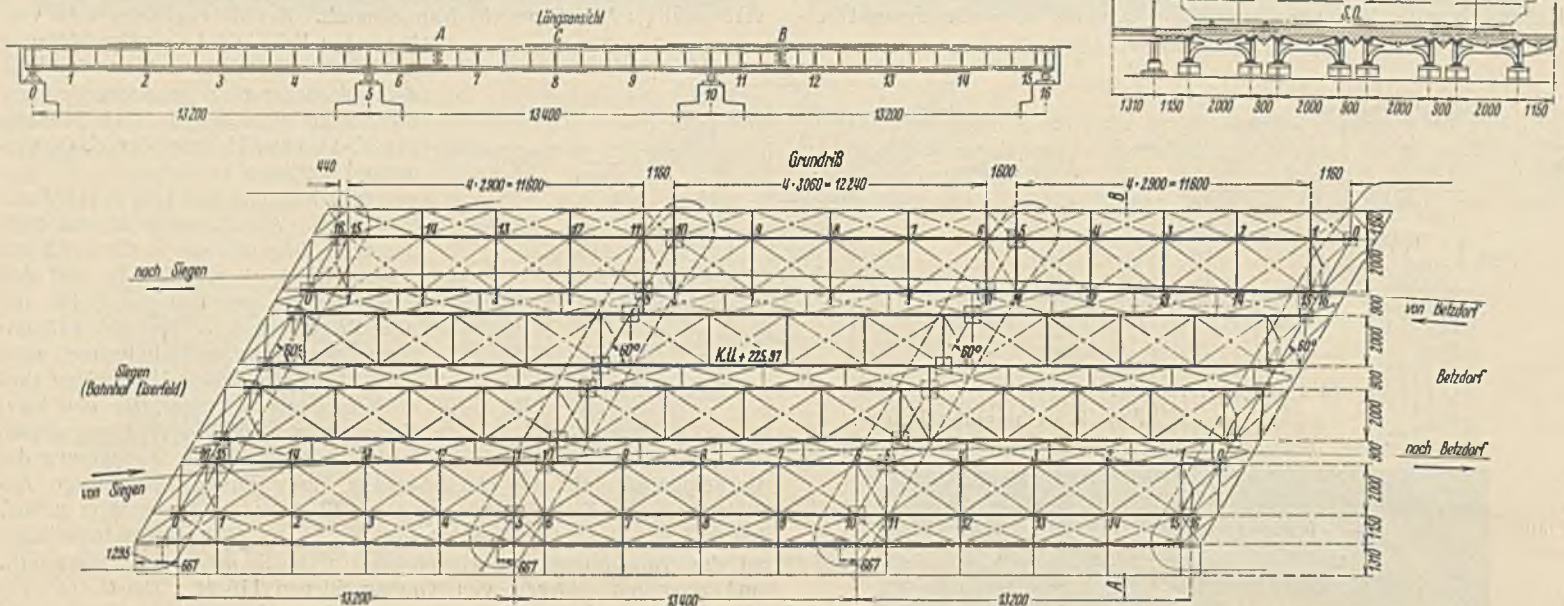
Grundriß, Längsansicht und Querschnitt der Siegbücke nach dem Umbau.
